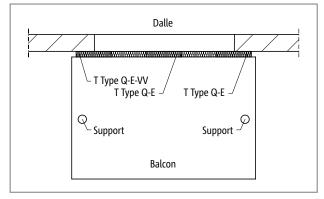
Schöck Isokorb® T Type Q-E, Q-E-VV : Balcon avec appuis
